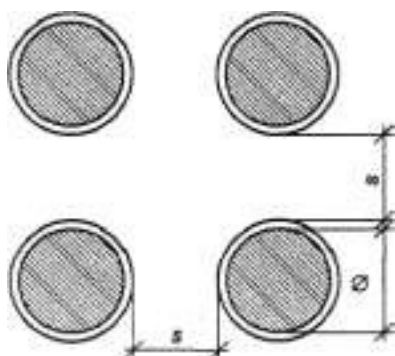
Rozmieszczenie zbrojenia w przekroju elementu żelbetowego
